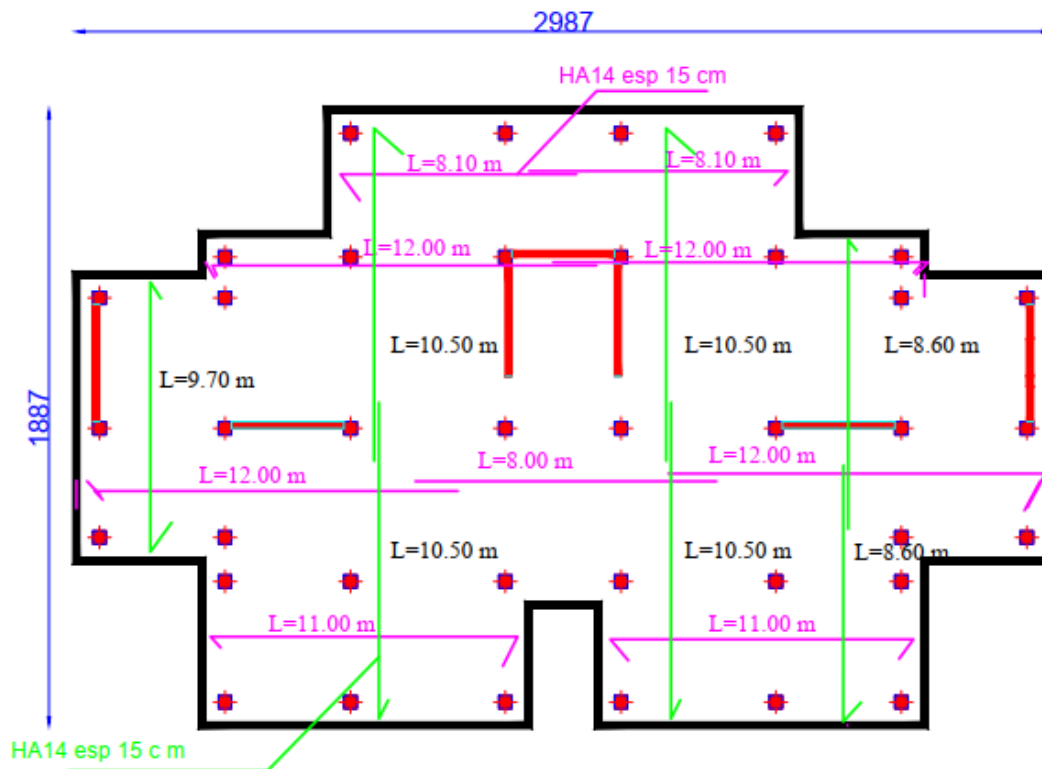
Plans de Coffrage et Ferrailage du Radier La nappe supérieure
